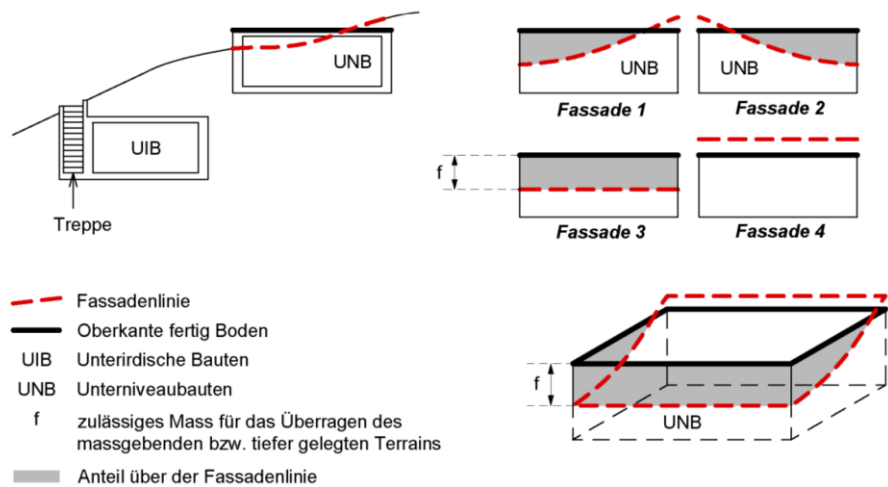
Schema unterirdische Bauten und Unterniveaubauten gemäss § 2b und 2c ABV
